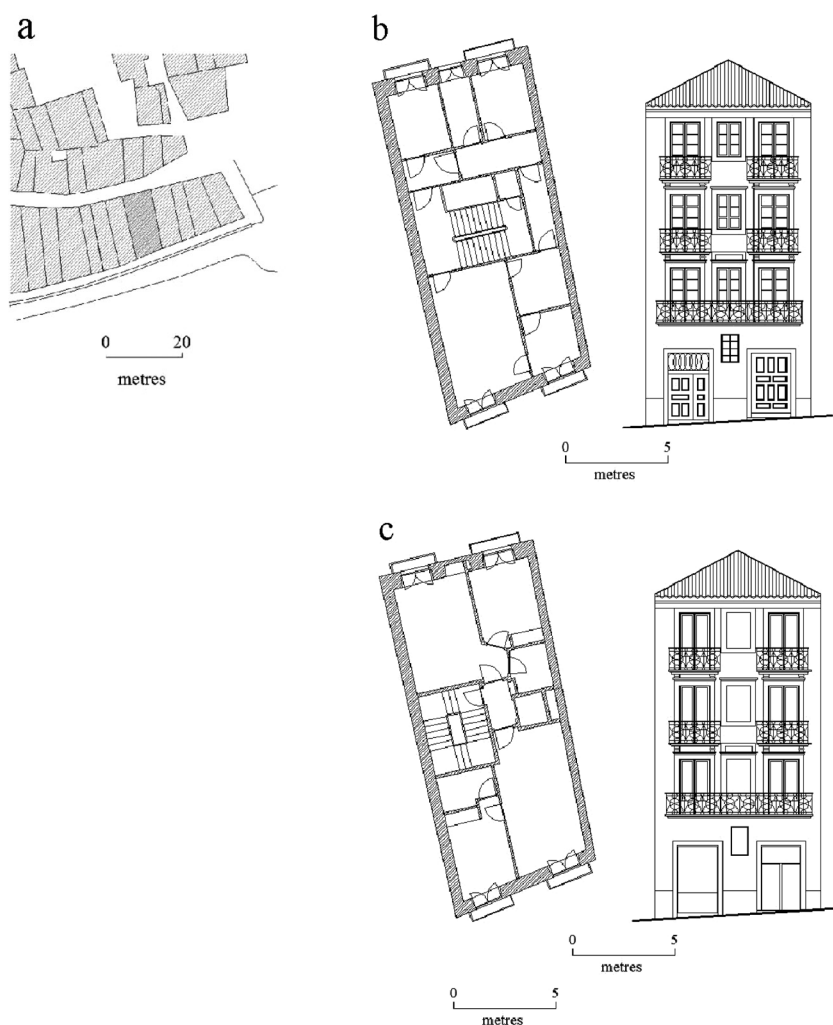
Transformação da estrutura interna e da fachada. Transformation of internal structure and facade. (a) Location plan. (b) Floor plan and northern facade before transformation. (c) Floor plan and northern facade after transformation. Sources: Oliveira et al., 2014.
